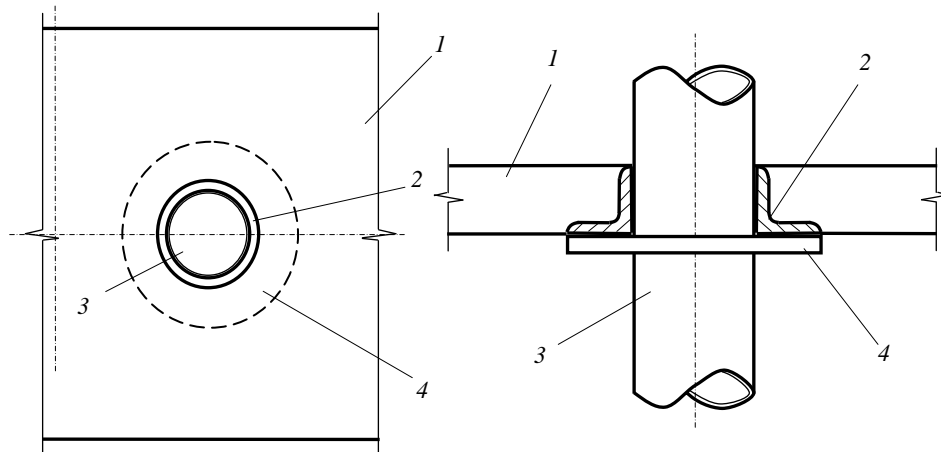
Вузол з'єднання надколонних плит безбалкового перекриття з труобетонною колоною: 1 – надколонна плита; 2 – обрамлення зі сталевих кутиків; 3 – колона; 4 – сталевий диск
